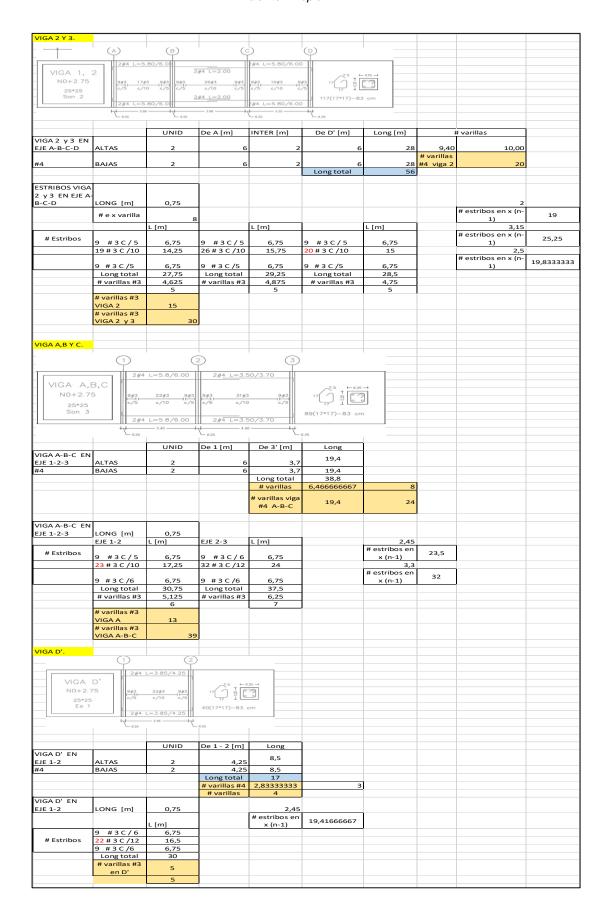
Cuadro Resumen – Cimentación y Estructuras en concreto - Parte 1.
